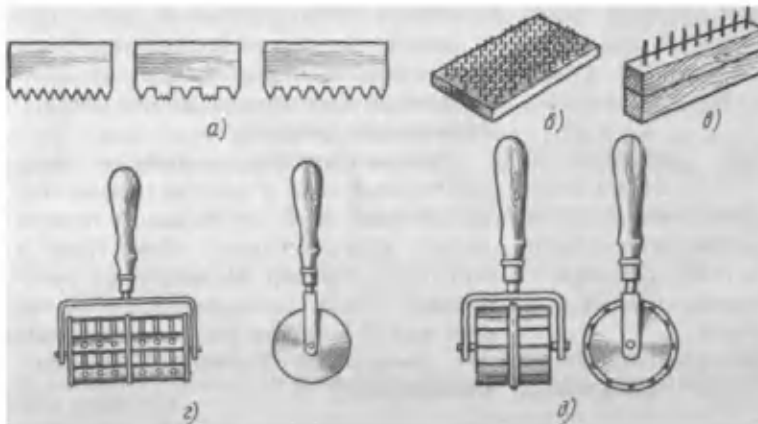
Инструменты для обработки декоративной штукатурки: а — цикля, б — гвоздевая щетка, в — гребенка, г — валик-шпоник
